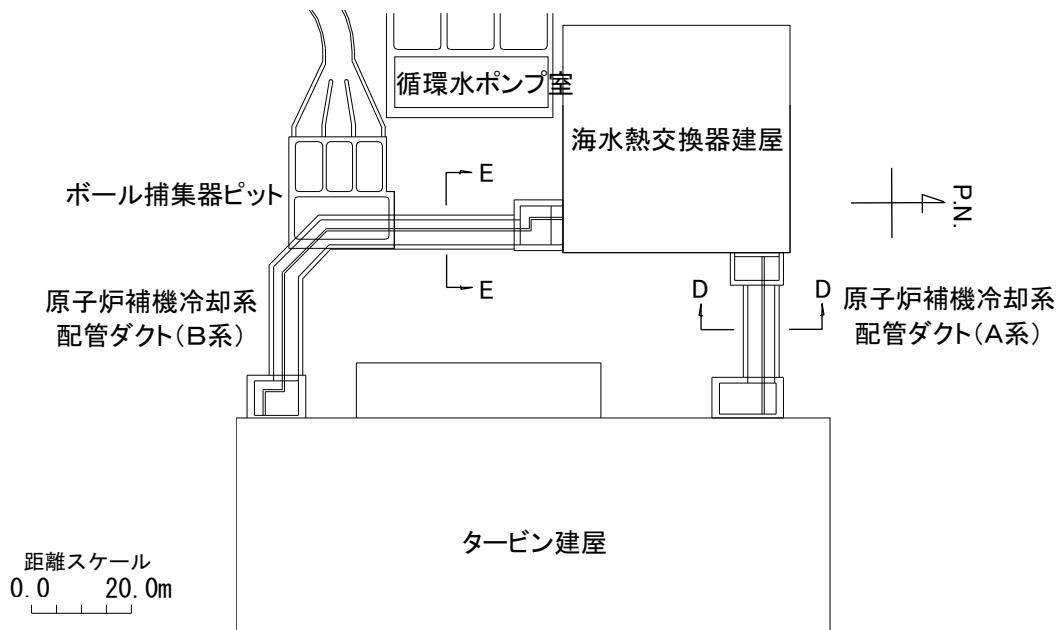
原子炉補機冷却系配管ダクト平面図
